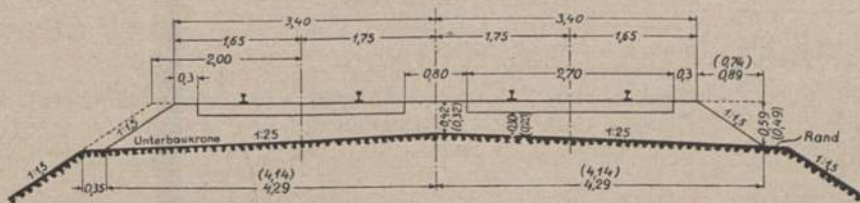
Bettungsquerschnitt zweigleisiger Hauptbahnen für Holzschwellen.
